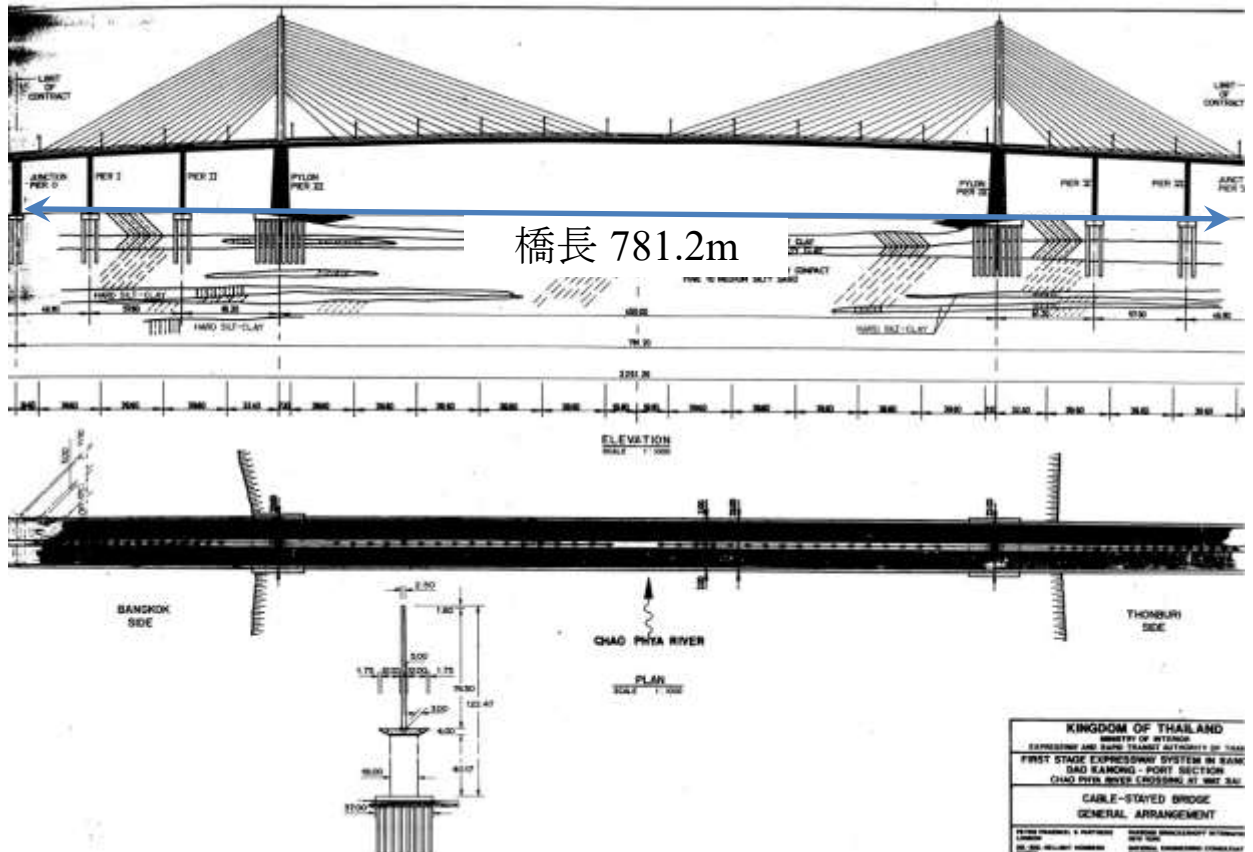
ラマ 9 世橋 側面図、平面図、主塔断面図
